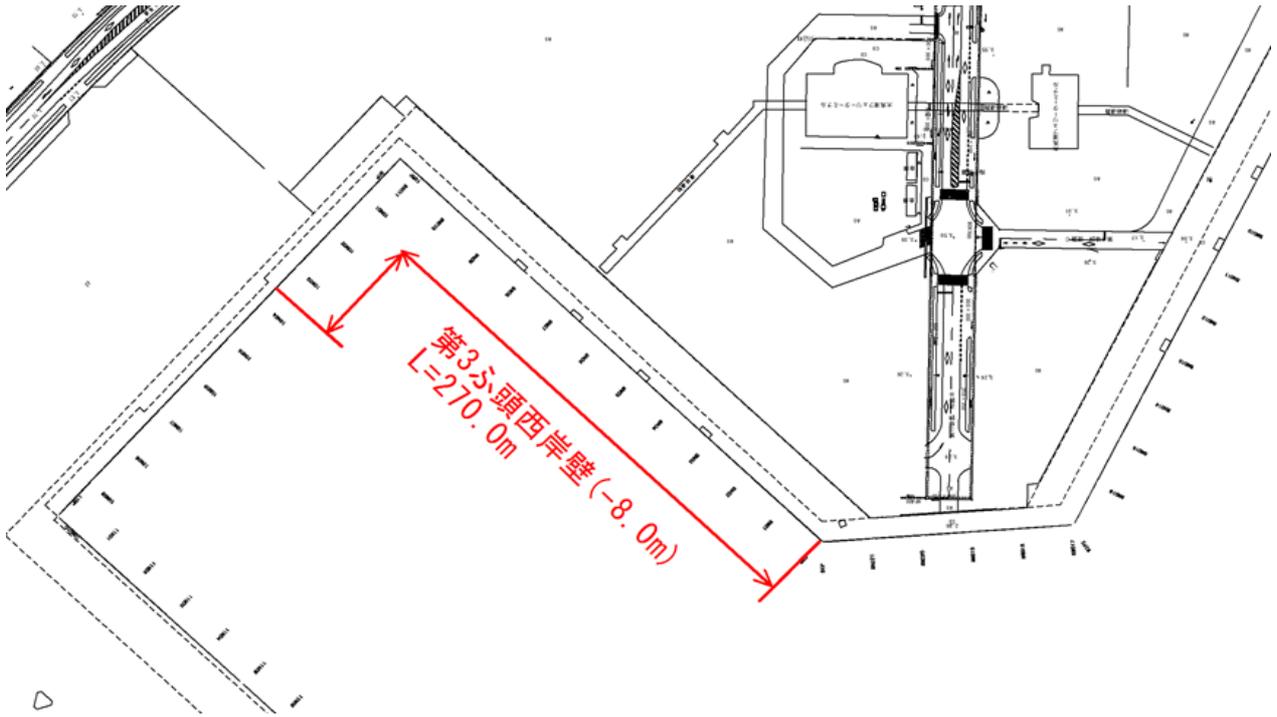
No.34 大洗港区_第3埠頭地区西岸壁 (-8m) の平面図 (被災前)
